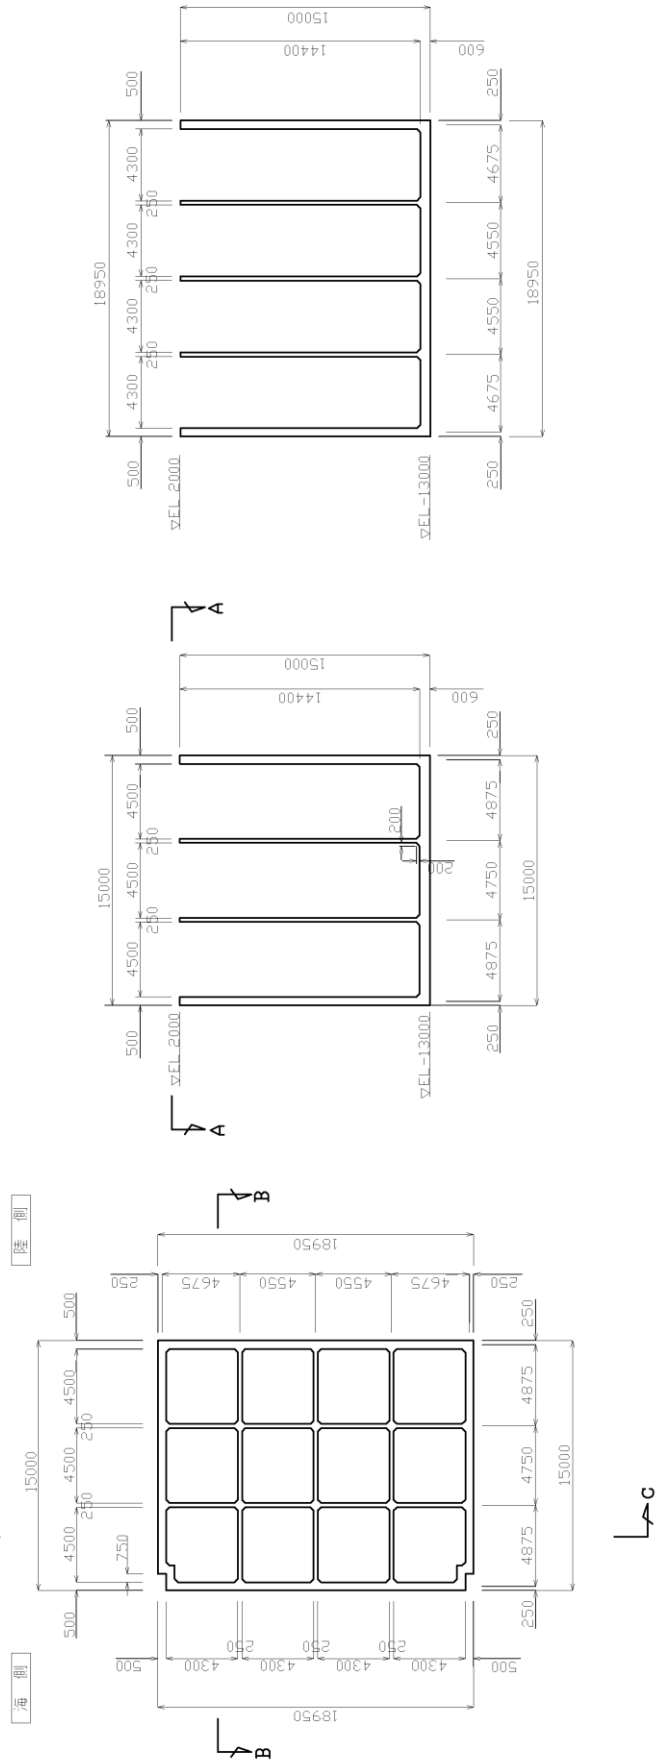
(8) 防波壁 (波返重力擁壁) のケーソン構造図 (断面図) (④-④断面)
